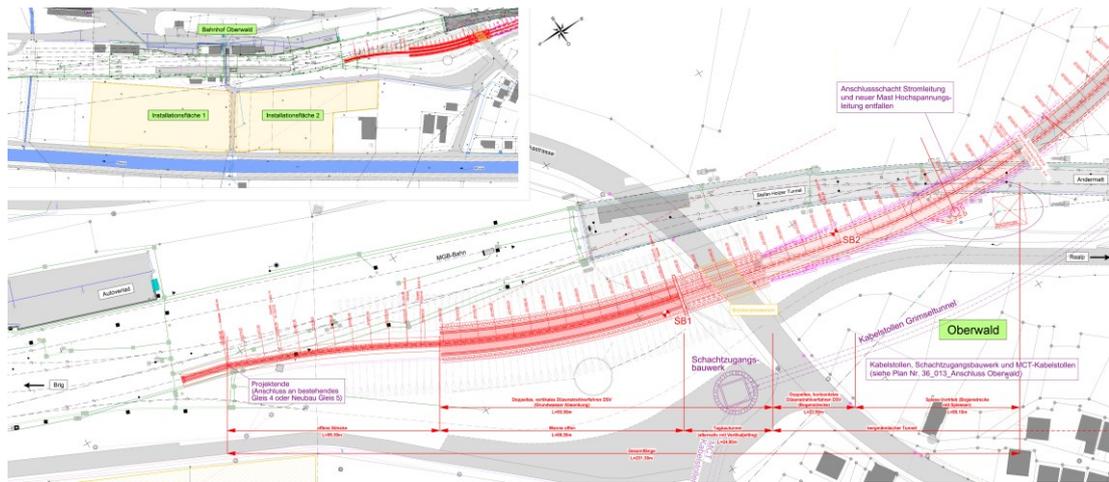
Situation Einfahrt Oberwald (Plan SPI mit Ergänzungen aufgrund System 3)
